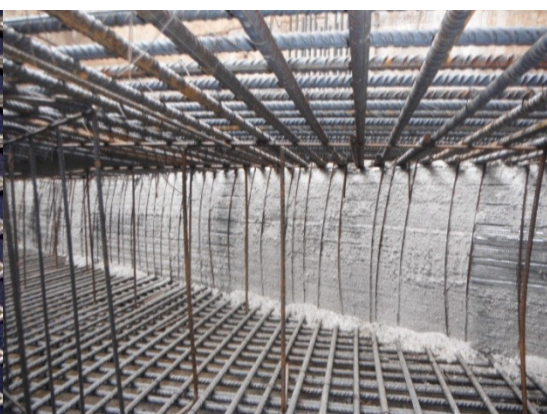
Divisão das áreas a betonar do ensoleiramento
